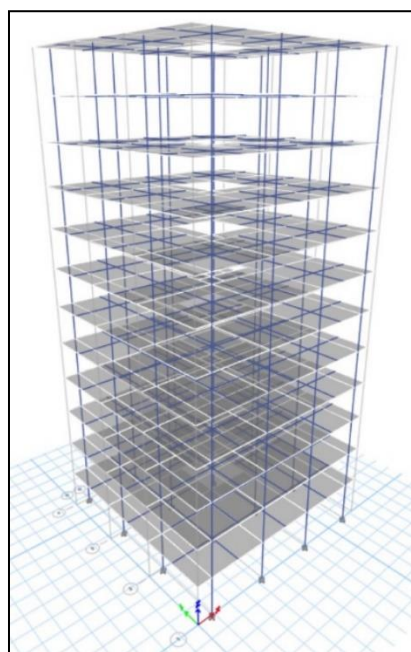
Modelo 3D en base rígida (Sin Aislamiento de base)
